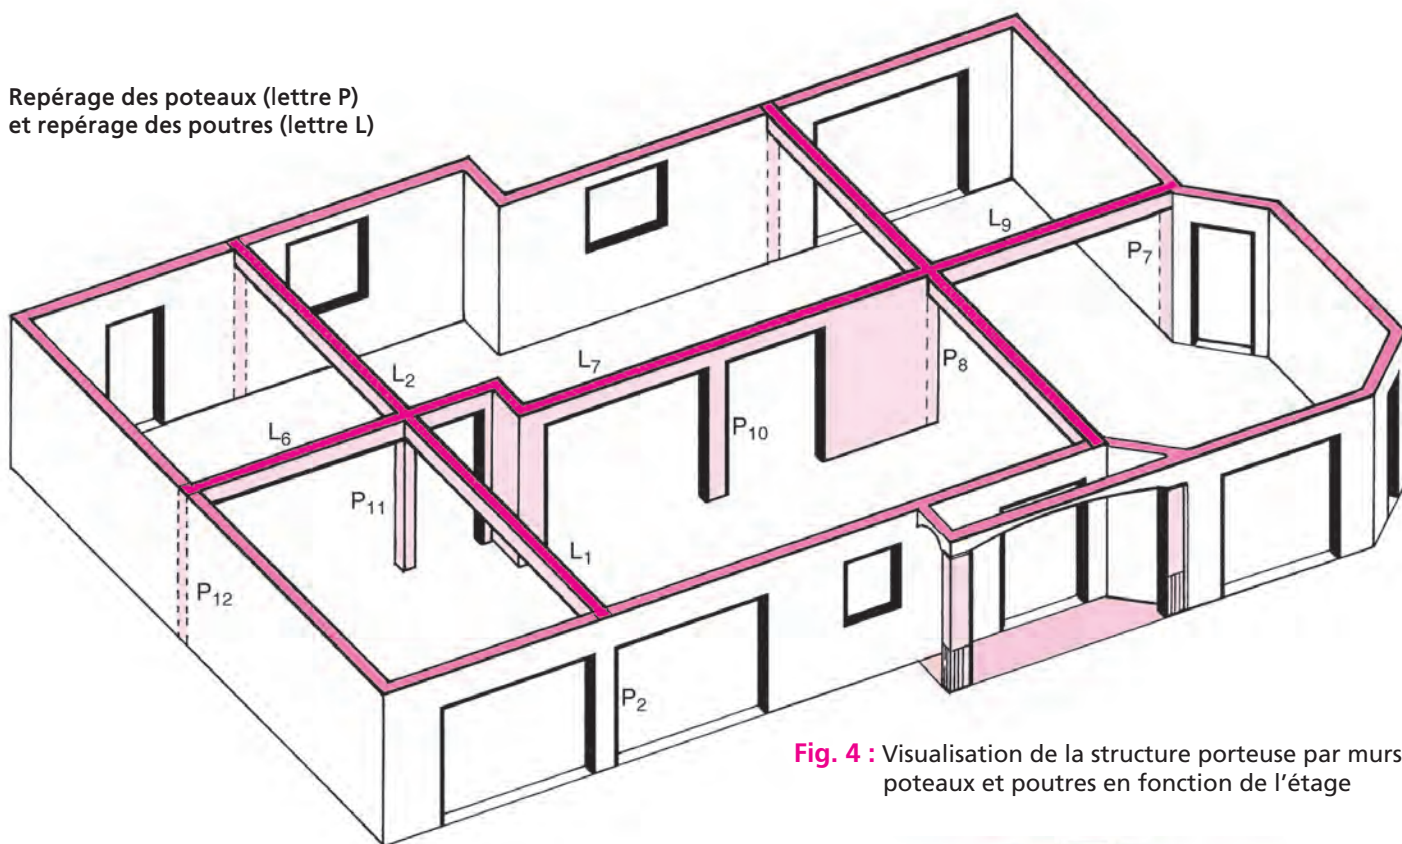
Visualisation de la structure porteuse par murs, poteaux et poutres en fonction de l'étage
